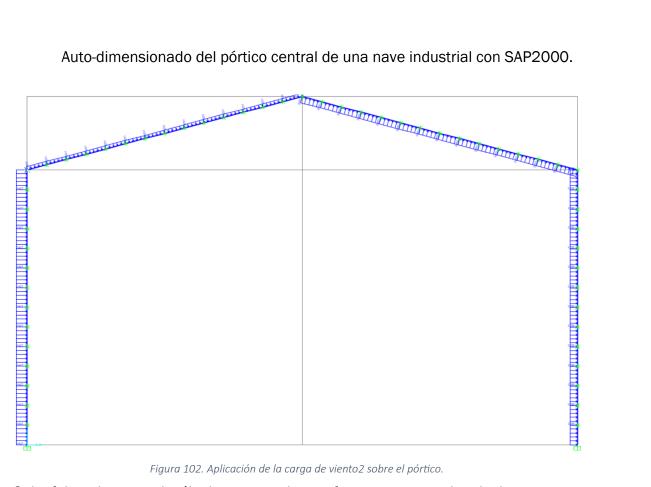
Aplicación de la carga de viento2 sobre el pórtico.
